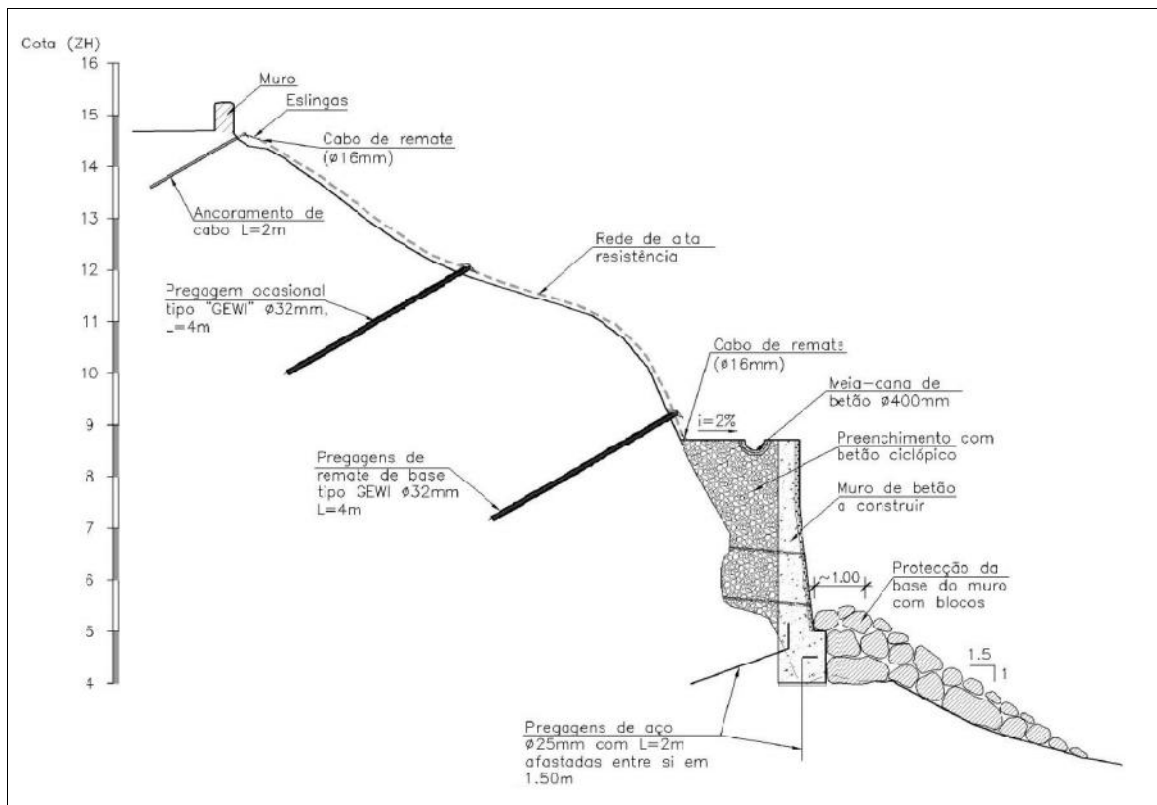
Perfil Tipo - Zona F:- reconstrução do muro na base da arriba, colocação de redes de alta resistência (Silva *et al.*, 2012).
